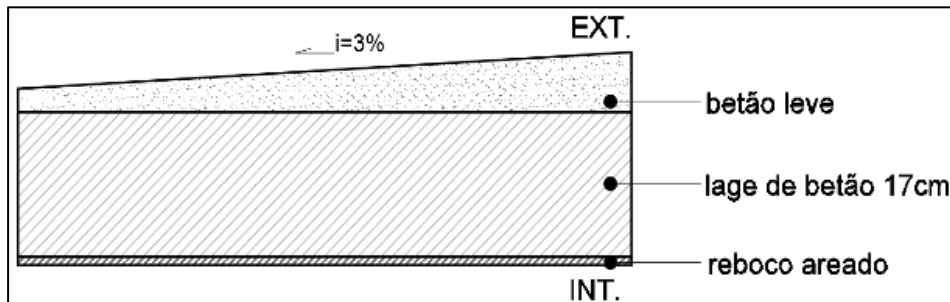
Corte da laje de cobertura na zona suja e corredores
